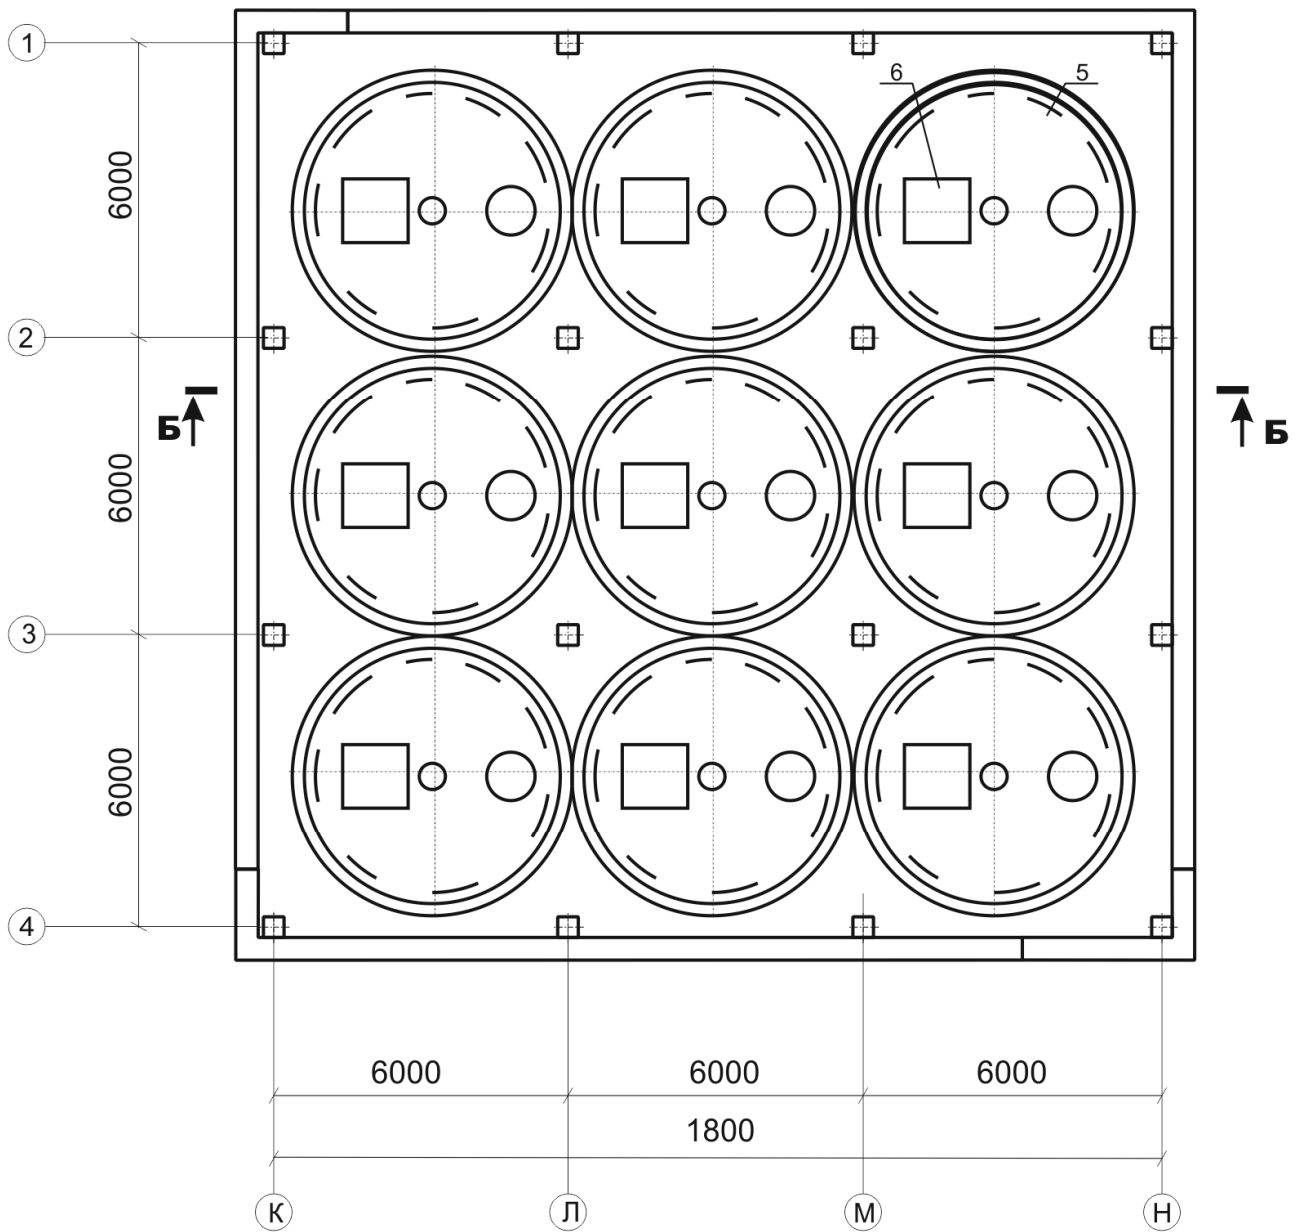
План третьего этажа с компоновкой оборудования [2]
